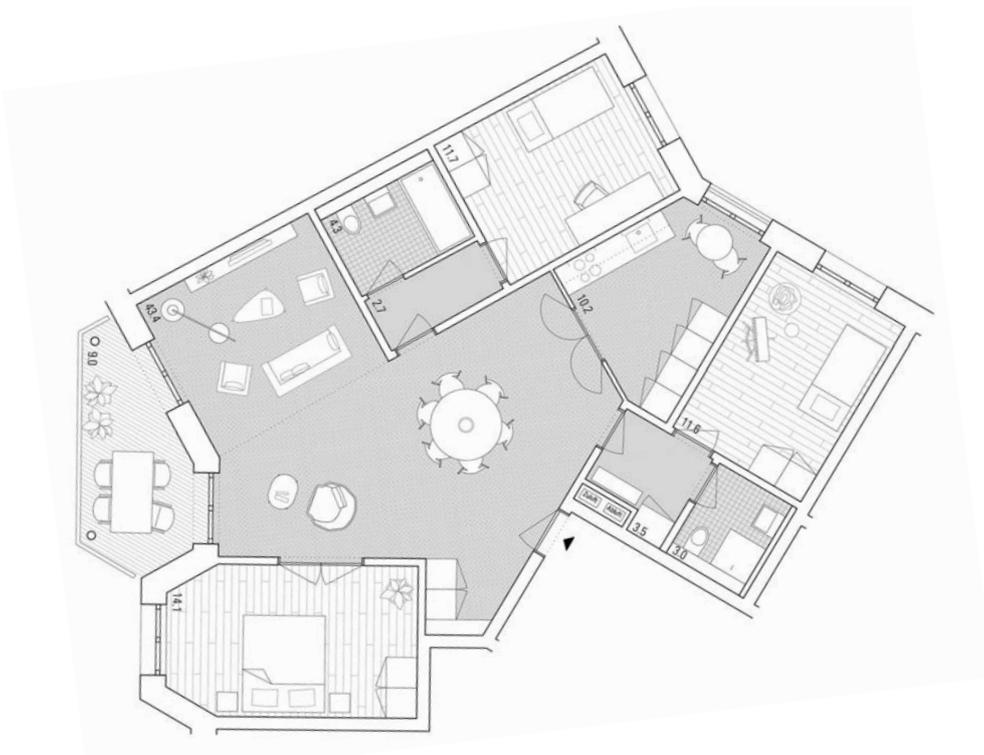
Wohnungsgrundriss 4.5 Zimmer - Whg.
